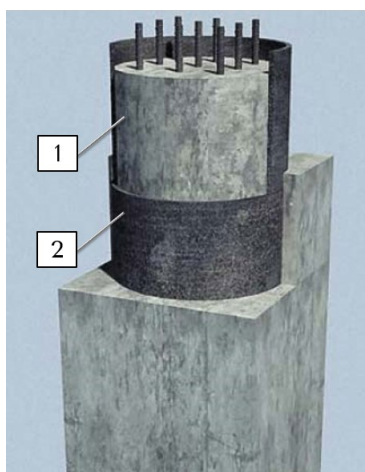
Модель трубобетонного элемента: 1 – железобетонное (бетонное) ядро; 2 – стальная труба-оболочка.
